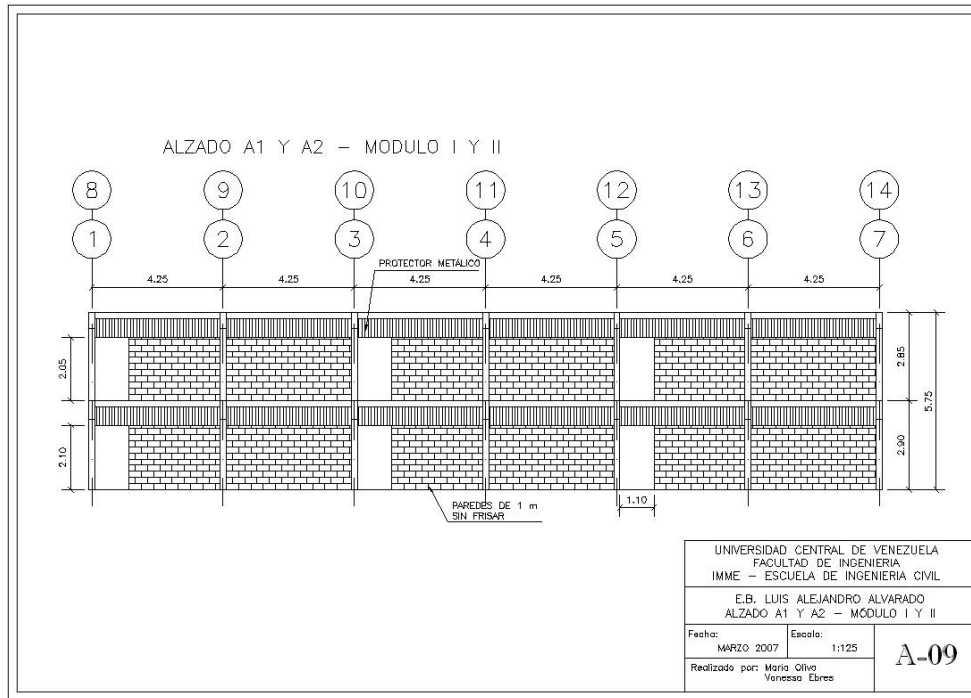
Plano de la Fachada Norte del Módulo I.
